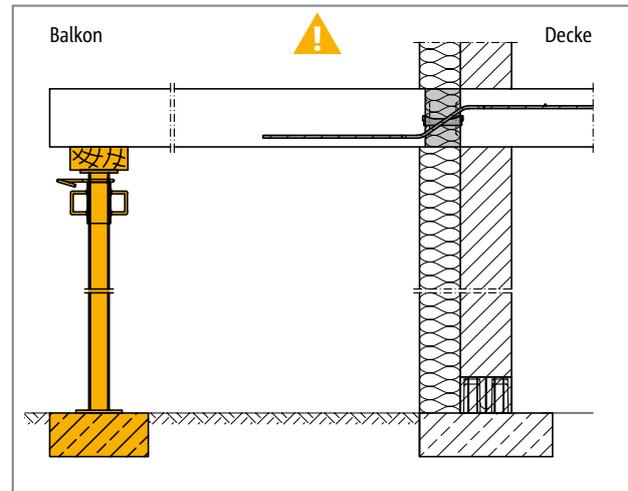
Schöck Isokorb® Typ QXT: Stützung durchgängig erforderlich
